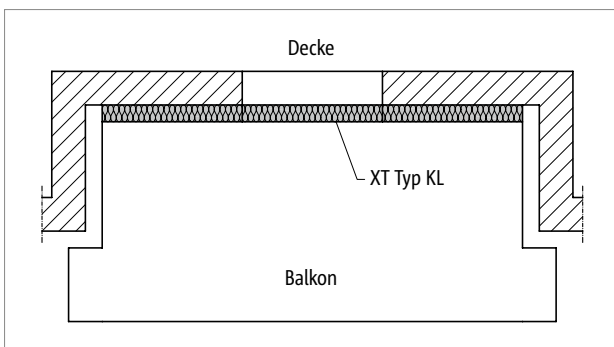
Schöck Isokorb® XT Typ KL: Balkon bei Fassadenrücksprung
